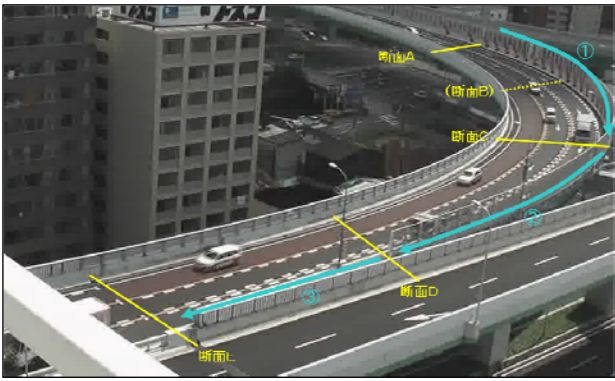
山王 JCT 北カーブ撮影状況と分析断面
